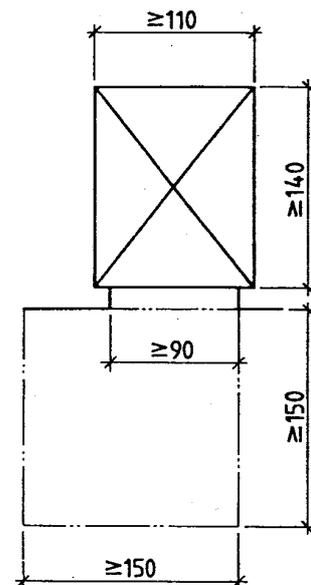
Lichte Maße des Aufzugsfahrkorbs und Bewegungsfläche vor den Fahrschachttüren
